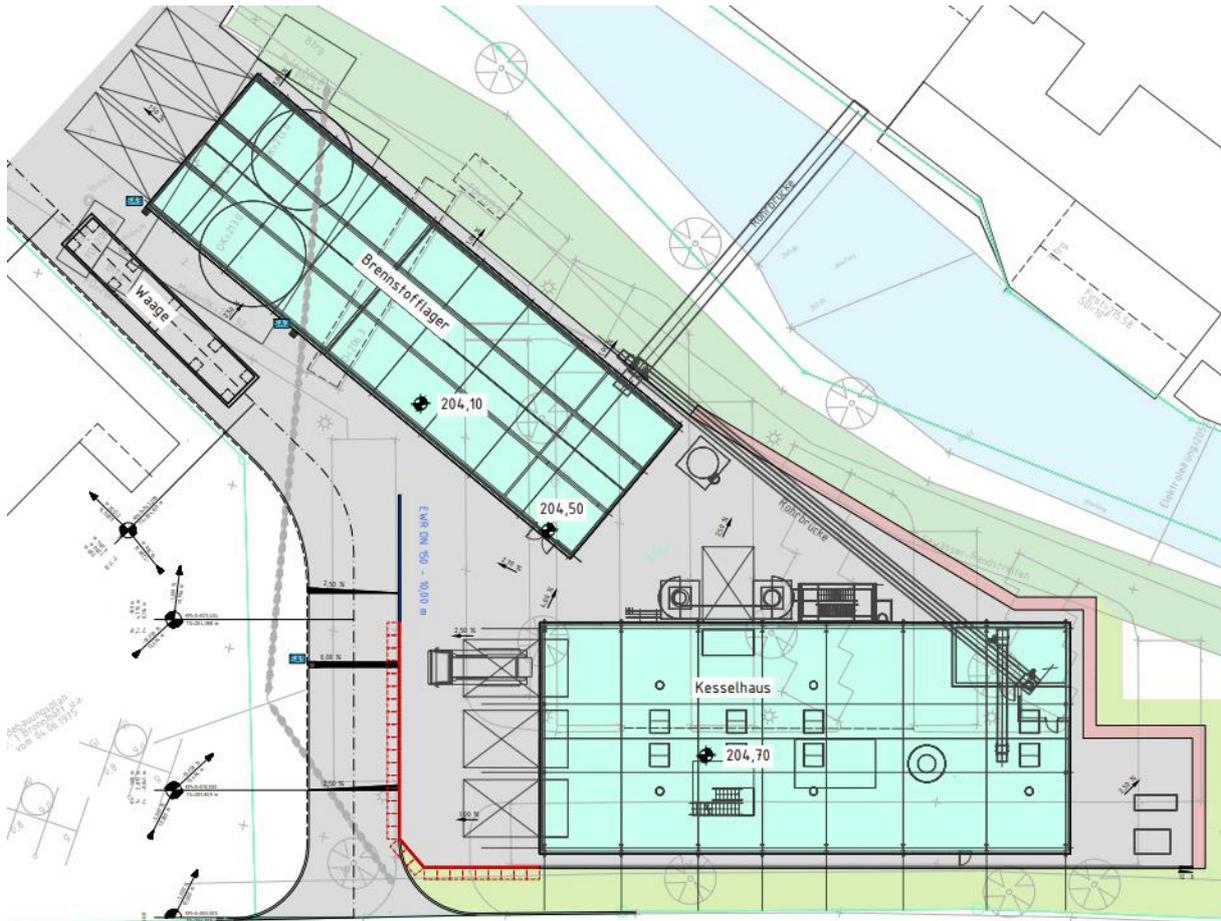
Lageplan des Planzustands (G+E GETEC 2022)
